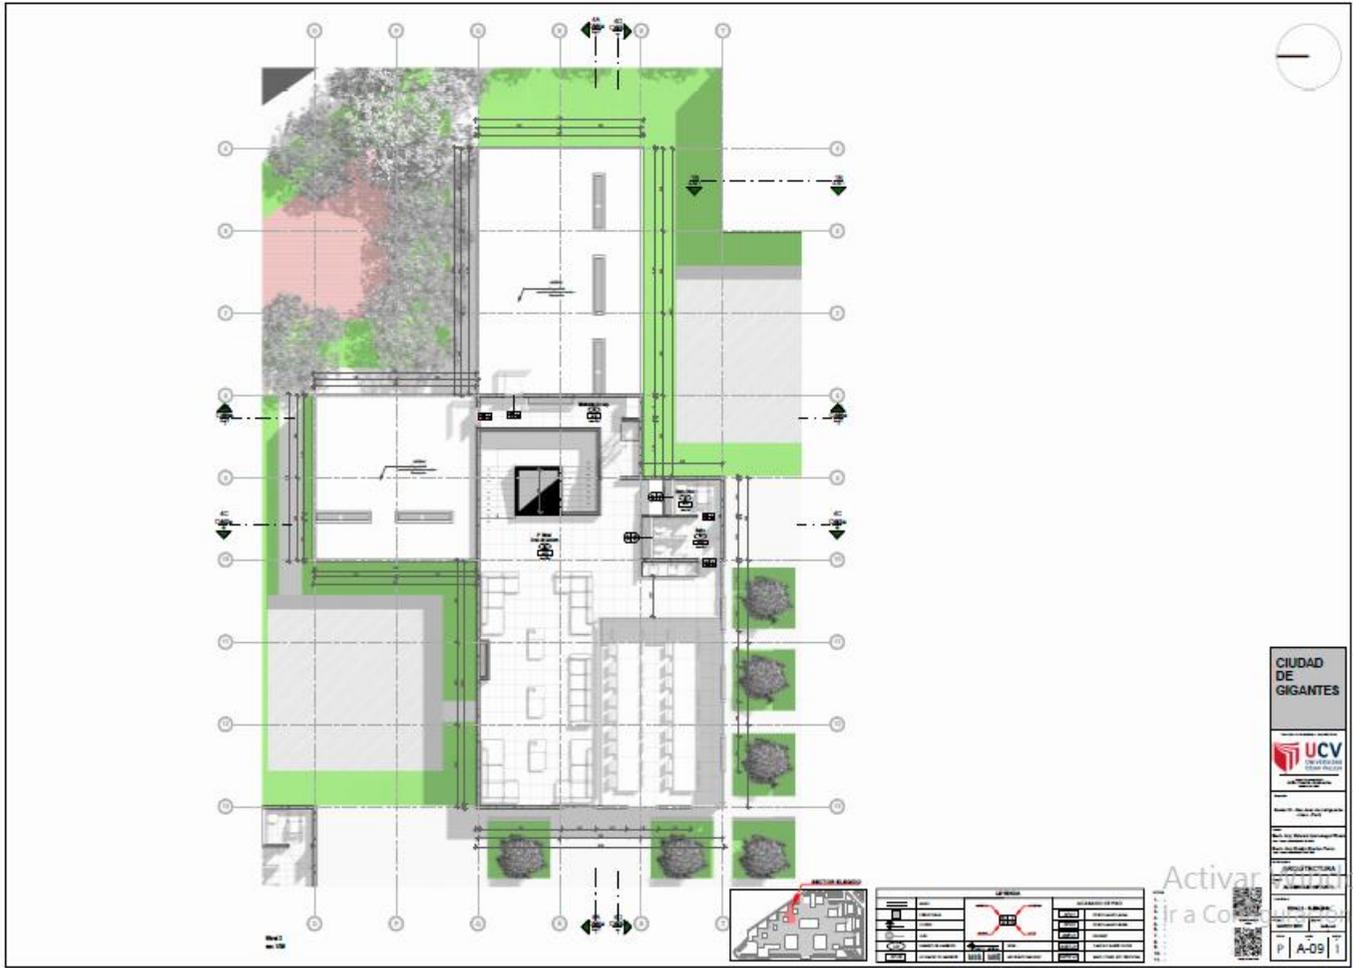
Plano de Planta Sector Residencia (Sector Elegido) Tercer Nivel
